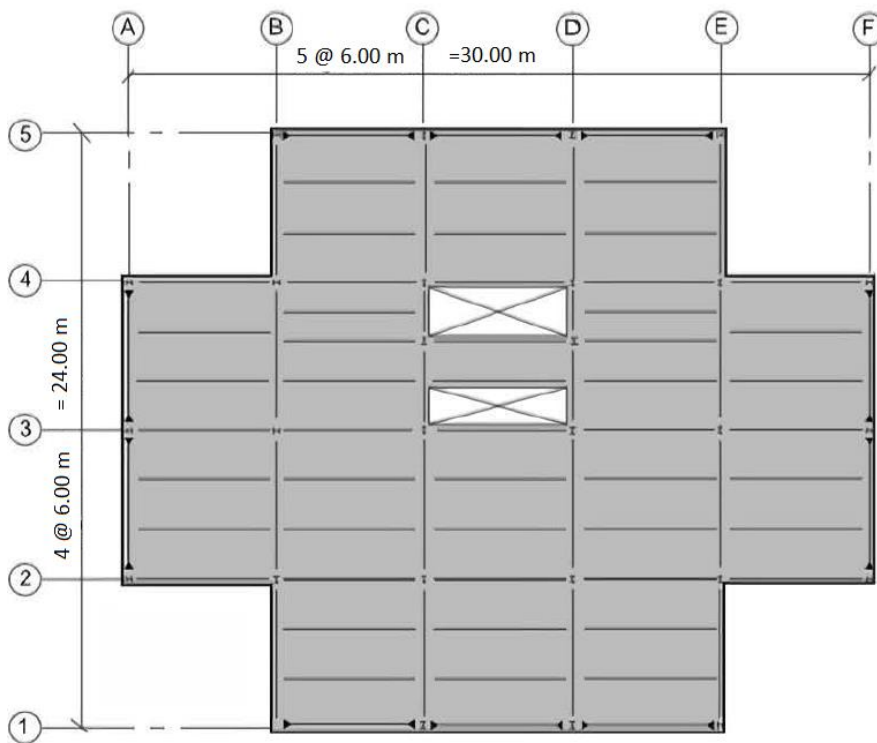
Distribución en planta de Pórticos del Sistema PRM
